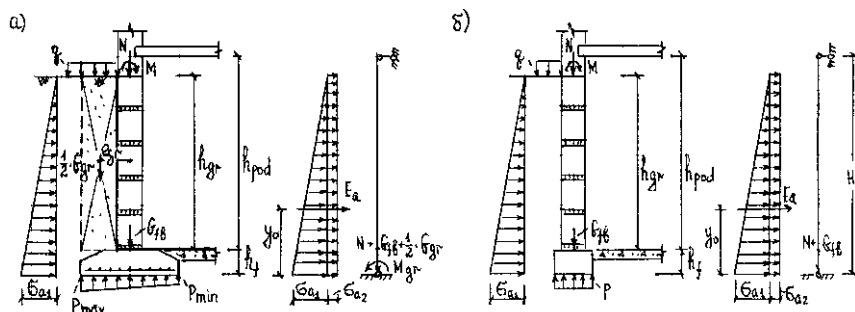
Расчётные схемы внецентренно нагруженного ленточного фундамента: а – при устройстве мягкой гидроизоляции поверху блок-подушки, б – для сборных фундаментов при $b_{fb}/b_f > 0,7$ и $b_f < 1$ м
